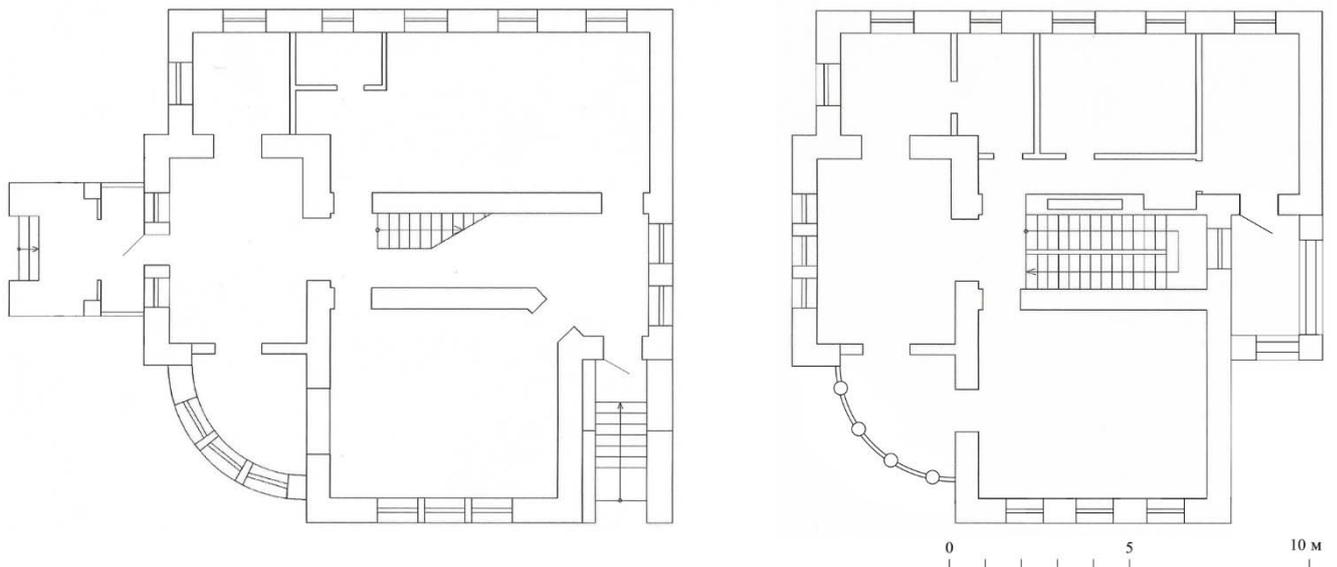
Здание дома П. Ф. Пахорукова. Планы первого и второго этажей
